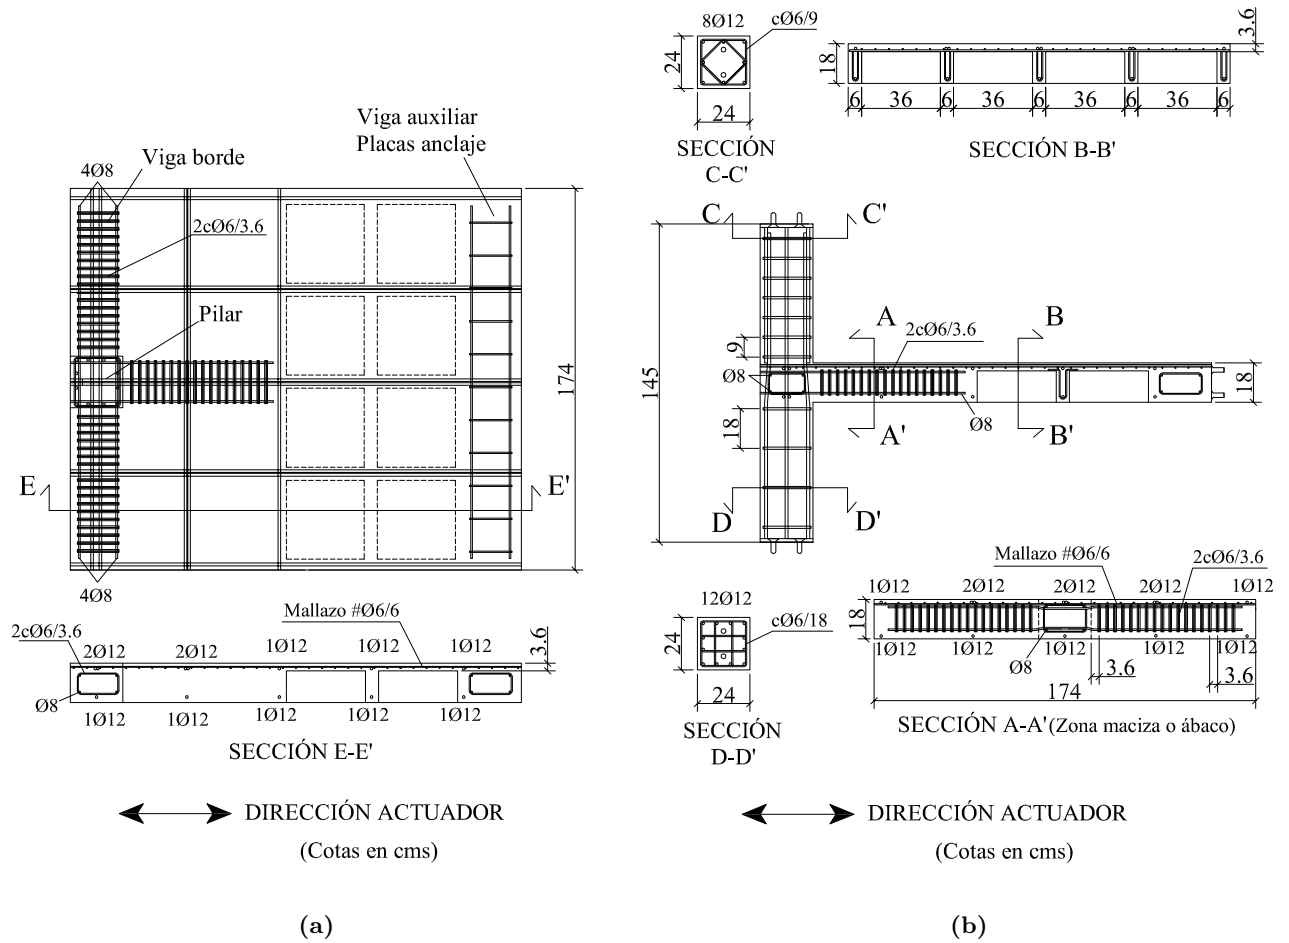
Geometría y armadura del espécimen de la conexión exterior: (a) Planta, (b) Alzado
